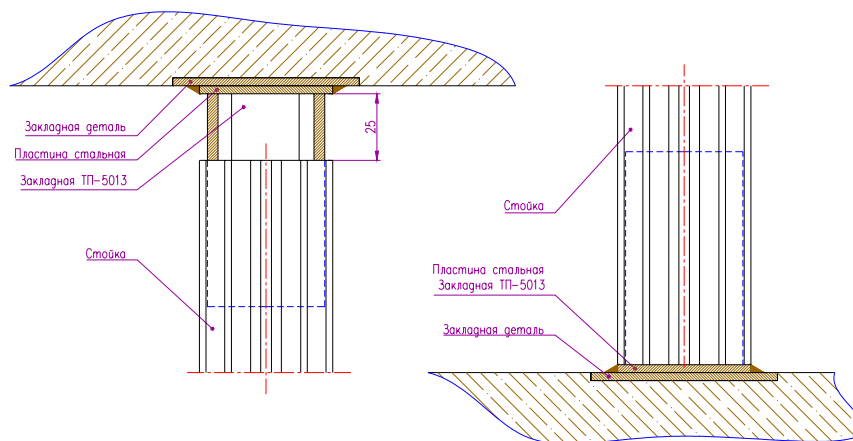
Верхний и нижний монтажный узел стойки ТП-50311
